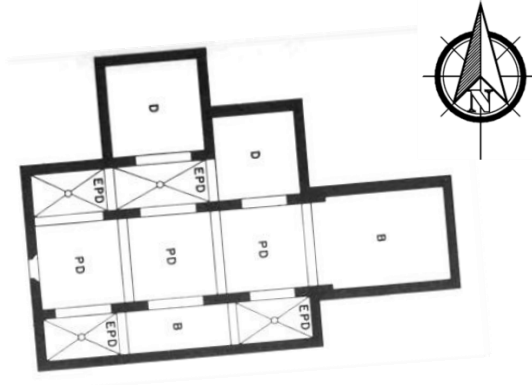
Planta esquemática de la iglesia de Belén²⁰⁹
